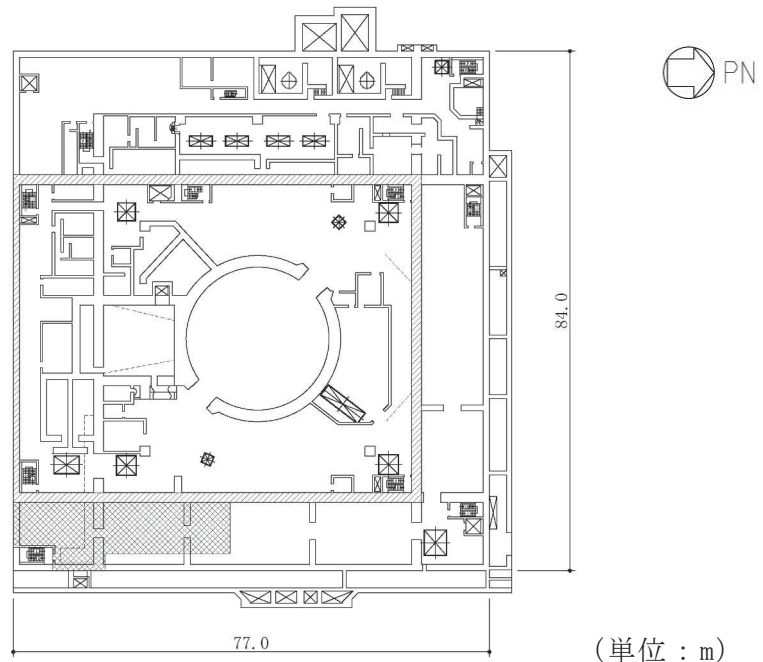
(1) 原子炉建屋原子炉棟 (二次格納施設) の範囲の平面図
